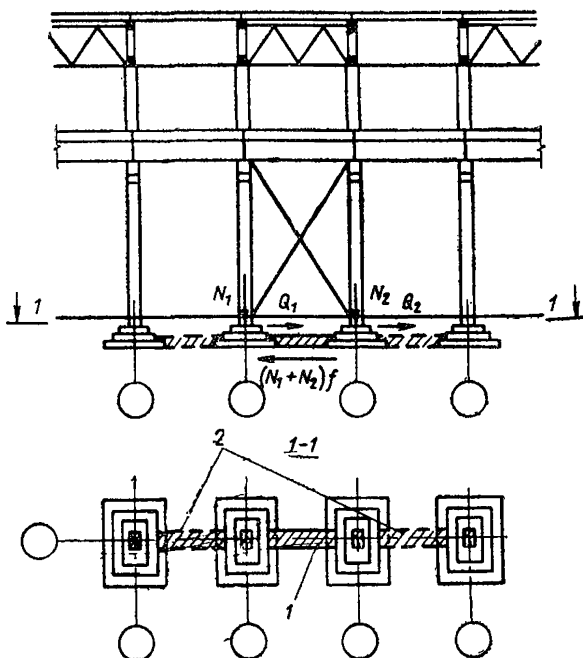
Схемы к расчету фундаментов колонн связевой панели на сдвиг
